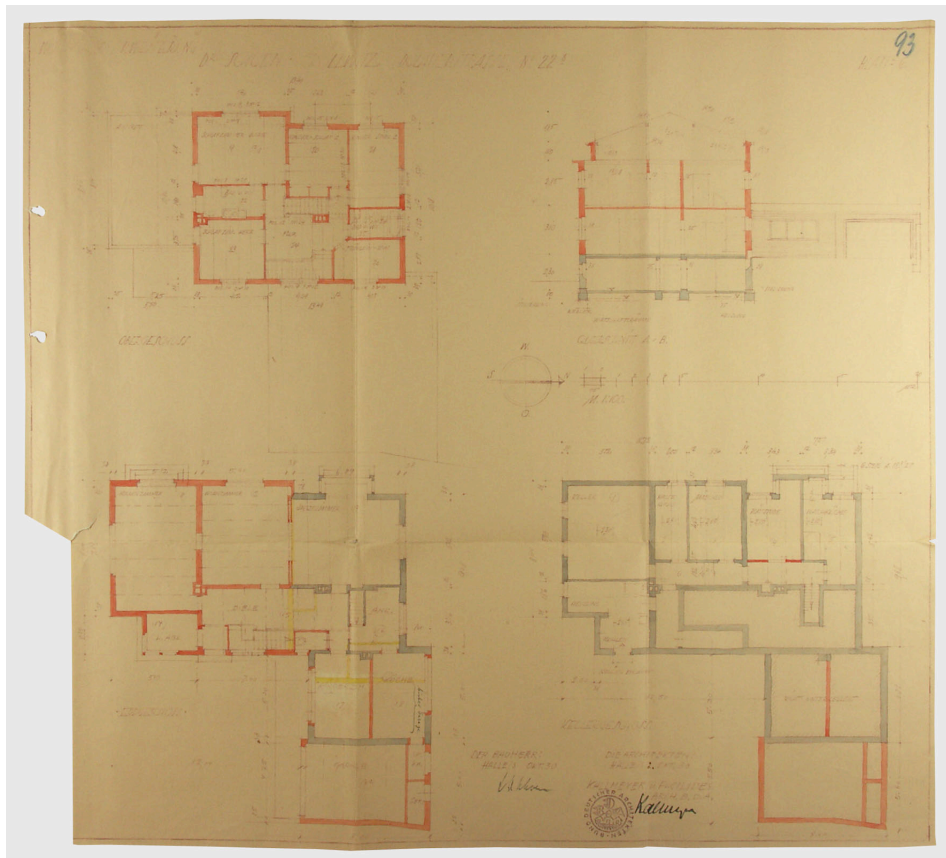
Wohnhaus Dr. Schoen in der Dölauer Straße 82 in Halle, Grundrisse, 2. Bauabschnitt, datiert 2. Oktober 1930.
